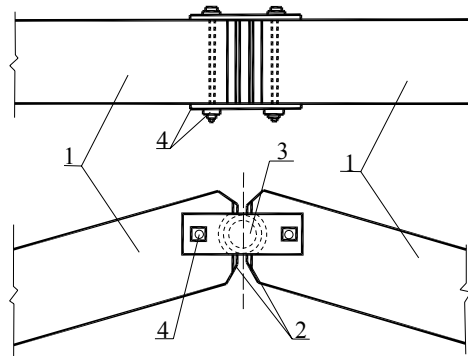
Конструкция конькового шарнира: 1 – ригель полурамы; 2 – закладные детали; 3 – труба М89 с бетоном В15; 4 – накладная деталь с болтами
